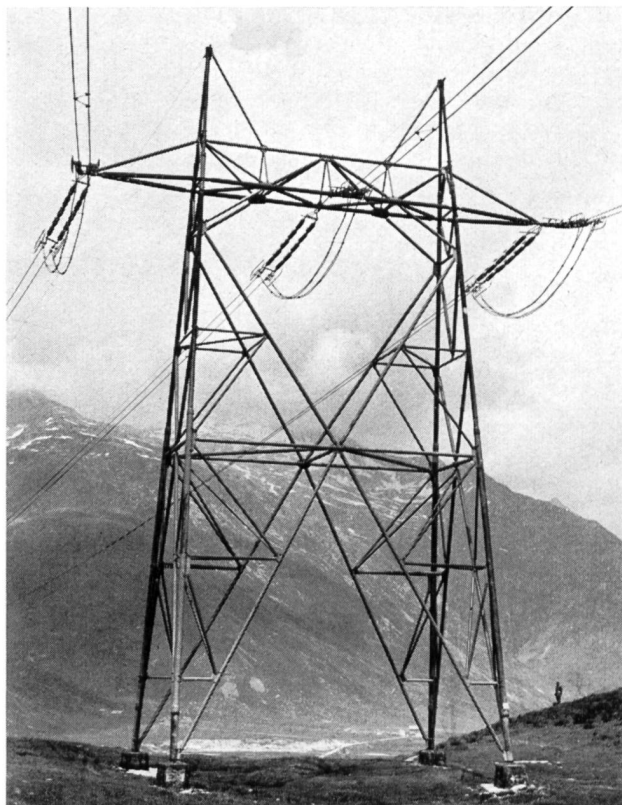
Winkelmast der Lukmanierleitung, 380 kV, vorläufig mit 220 kV in Betrieb (Photo Borelli, Airolo)
